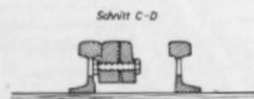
Schnitt C-D mit Bolzen der zusammengeschrubten Herzstückspitze.
